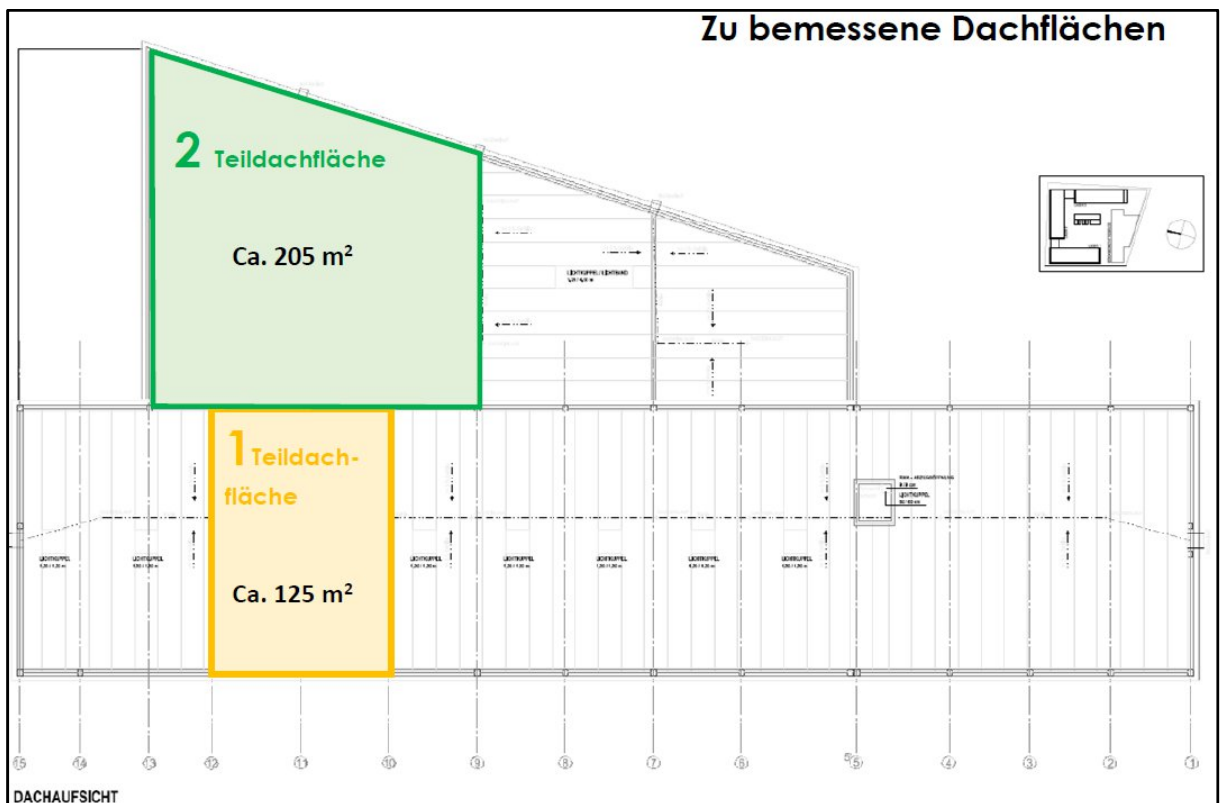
Zu bemessene Teildachflächen Werkhof Stammestraße [Quelle: LHH FB 67]
